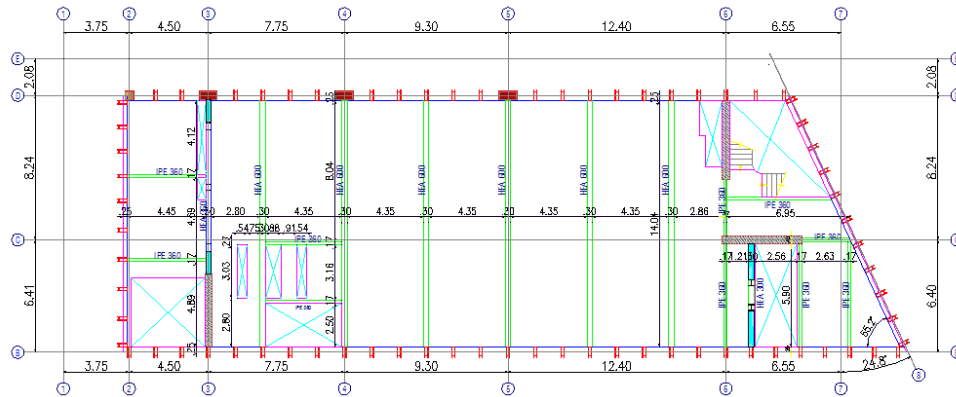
Planta típica del piso 3 ubicada a N + 10.00
